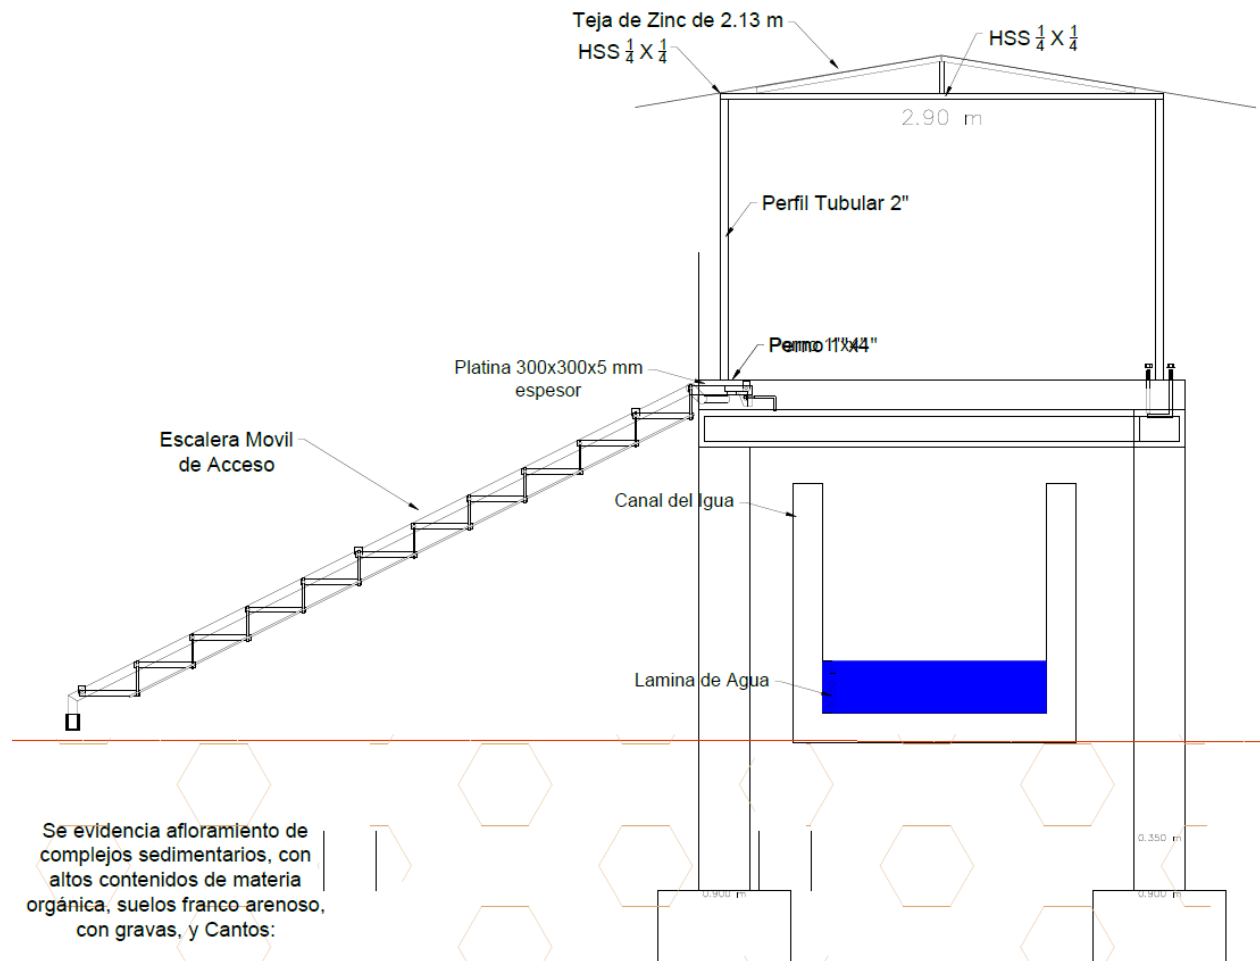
Diseño de detalle de estructura elevada tipo caseta para instalación y anclaje de la turbina: Primer detalle.
